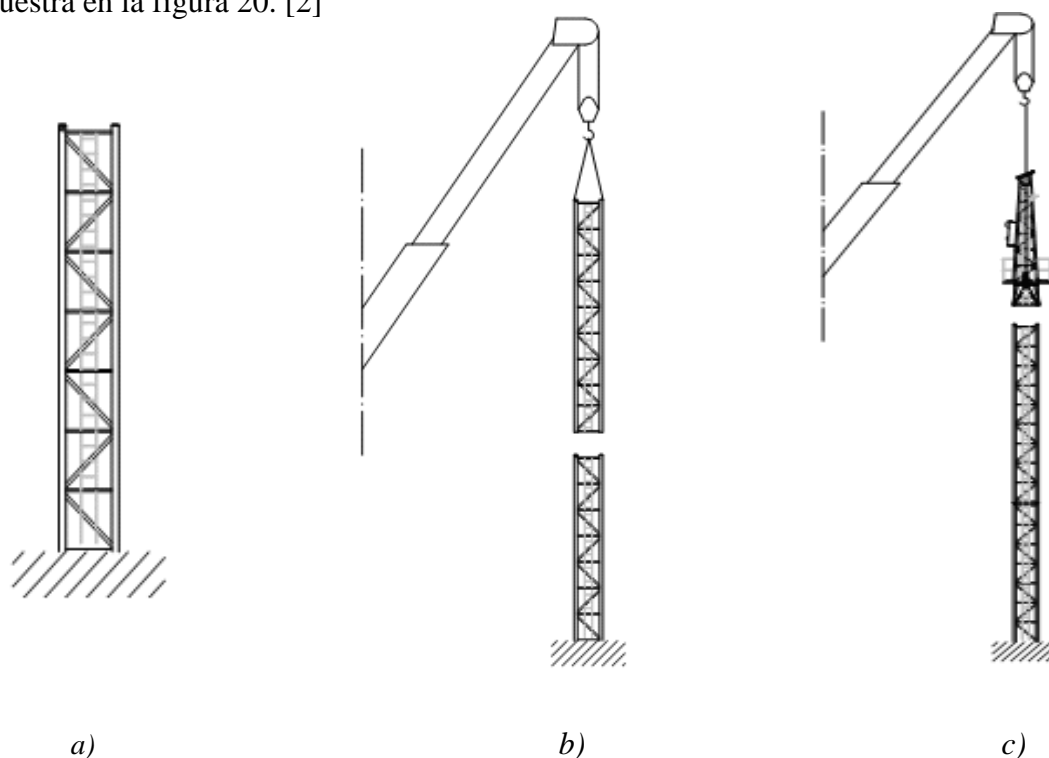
a) Montaje de la torre inferior, b) Montaje de los tramos de torre requeridos, c) Montaje del conjunto superior.
